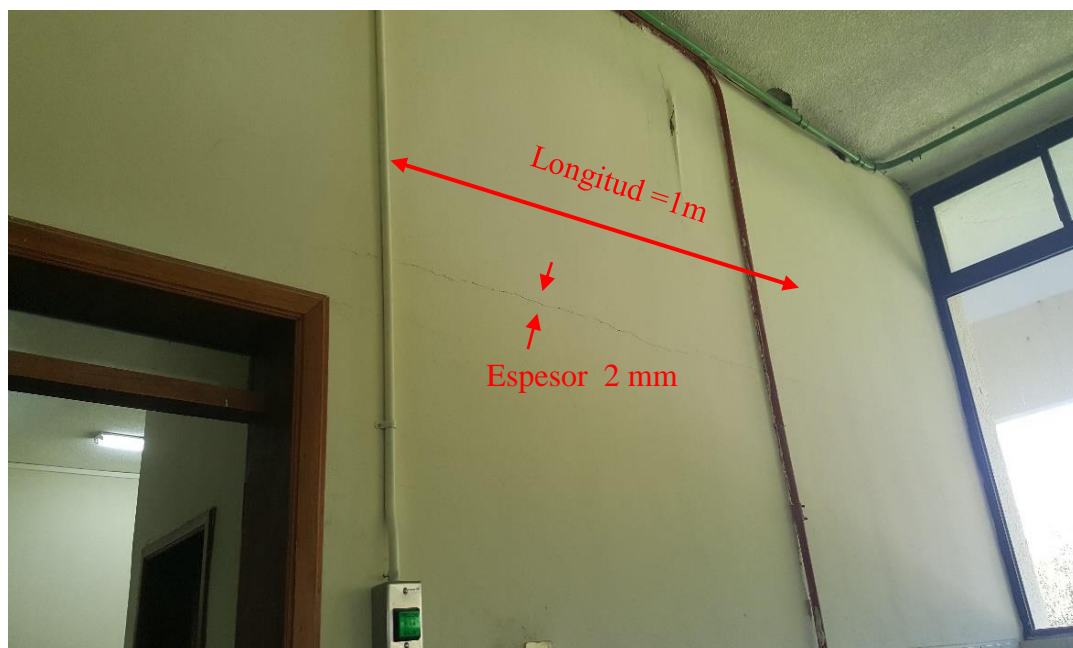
Grieta en mampostería, Planta alta eje C entre 1 y 2
